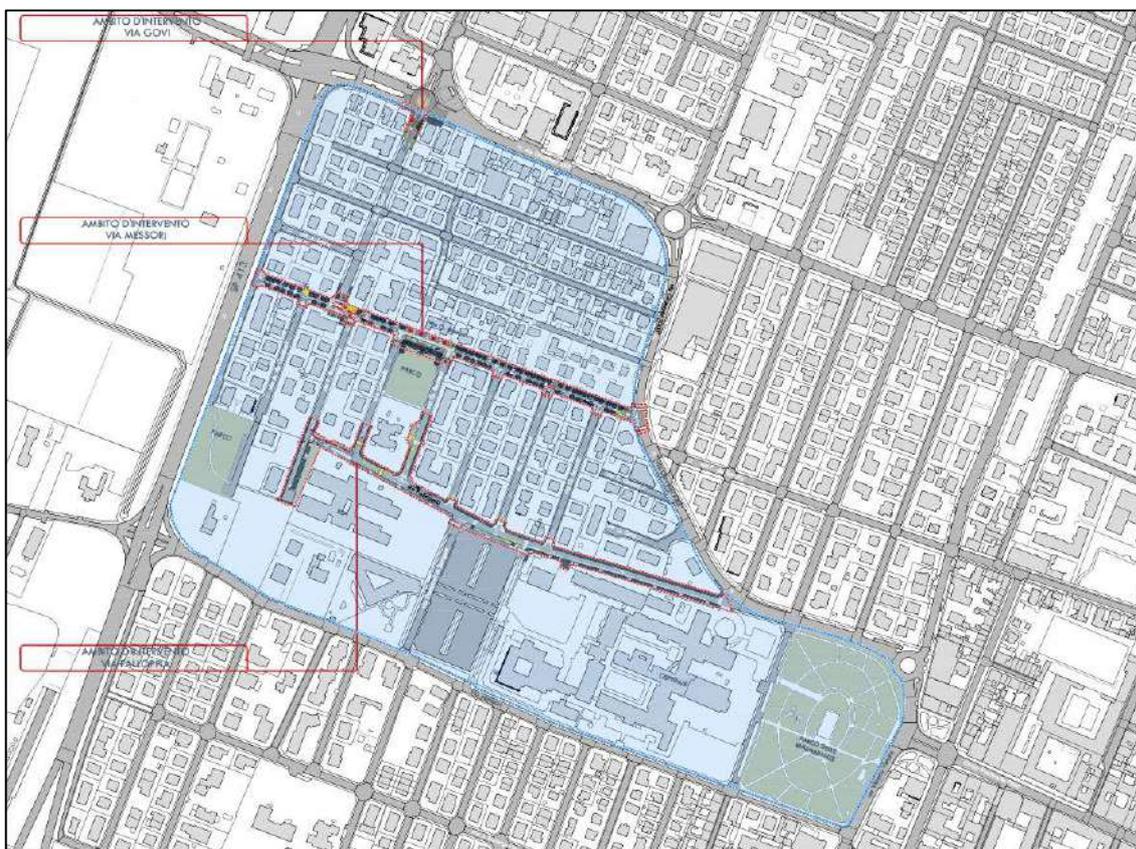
estratto planimetria di inquadramento area oggetto d'intervento
